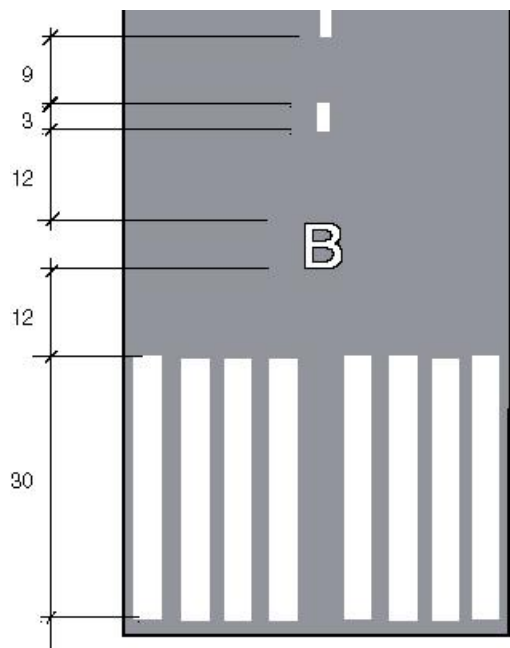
Centrumlinjemarkering, banklass 5-6.
